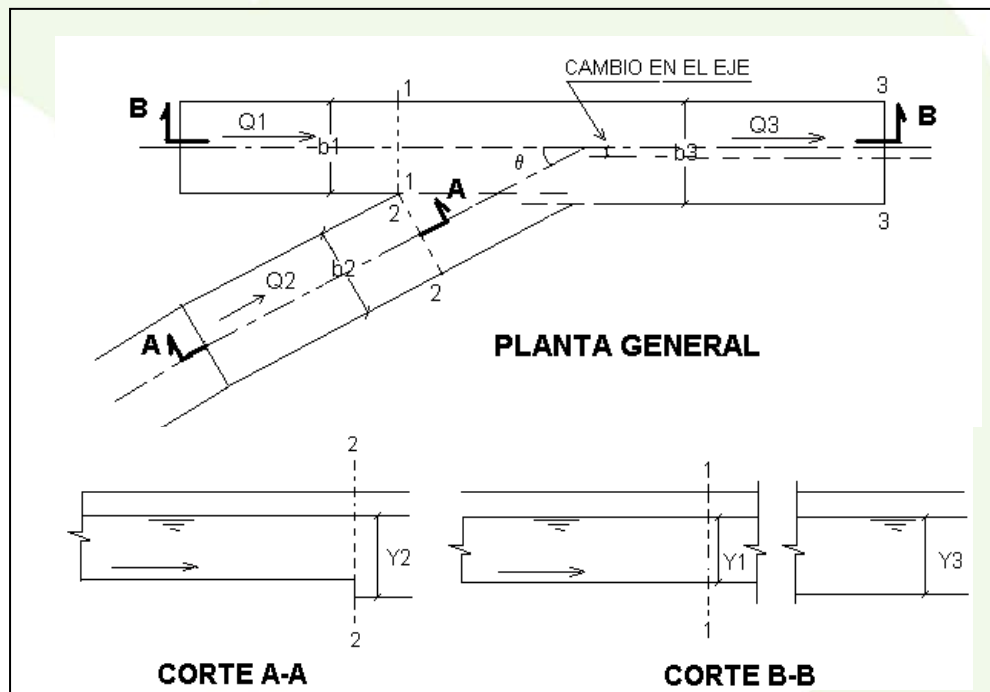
Unión de tuberías sin caída para diámetros mayores que 900 mm
